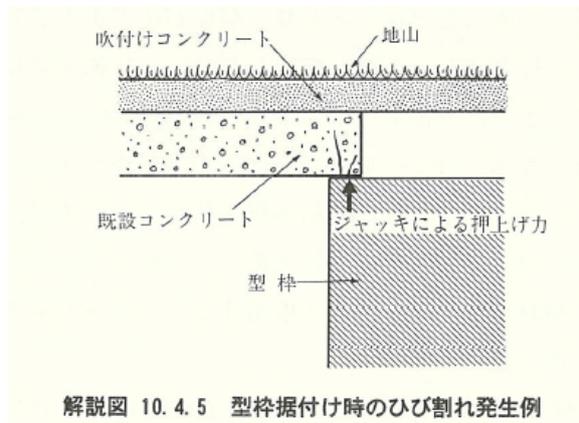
ひび割れ発生例¹⁾
